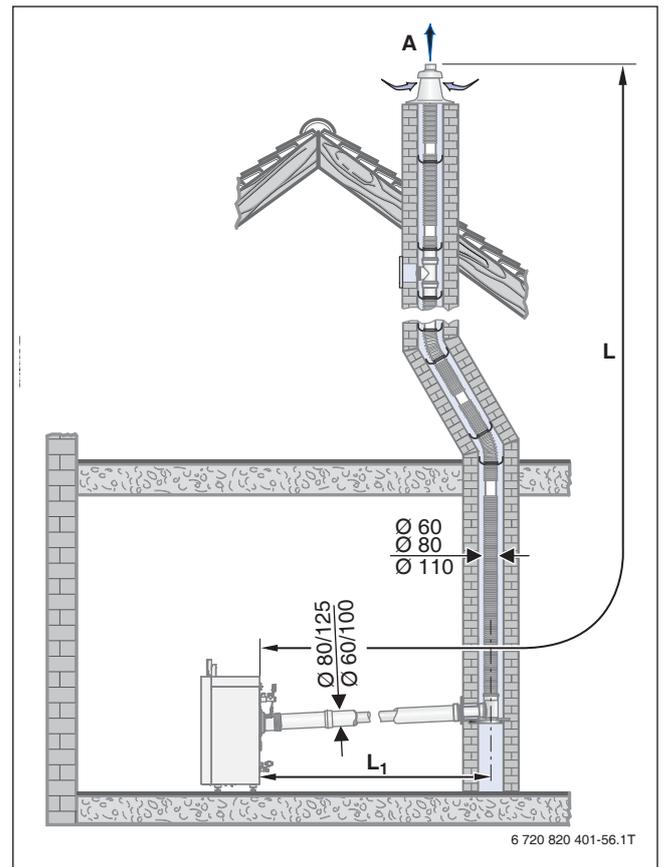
Montagevarianten mit dem Bausatz GA-K + ÜB-Flex
